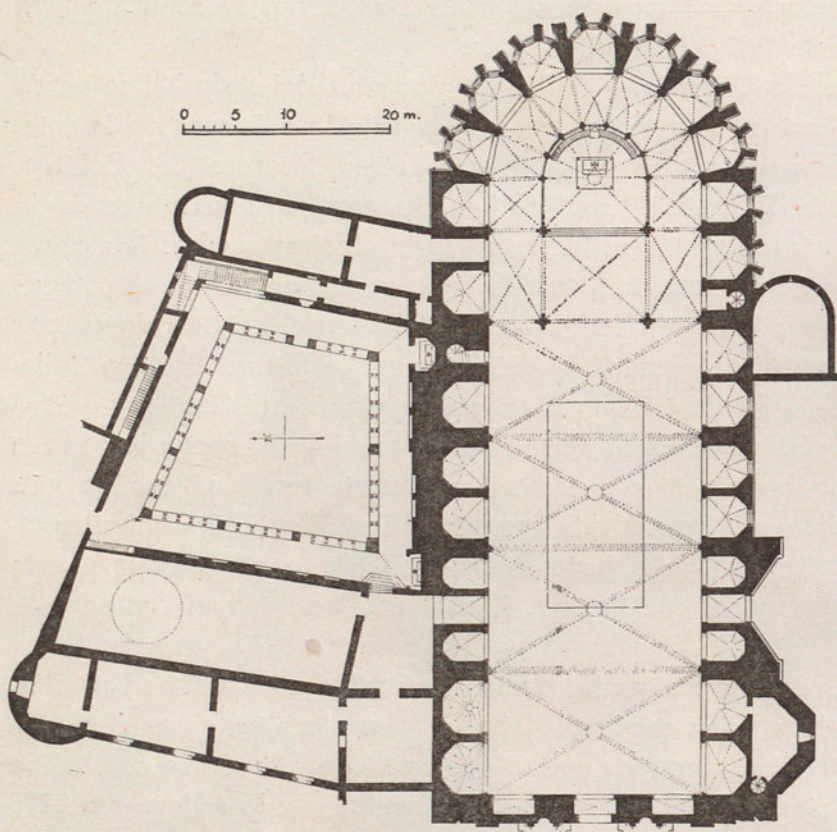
PLANTA DE LA CATEDRAL DE GERONA.
